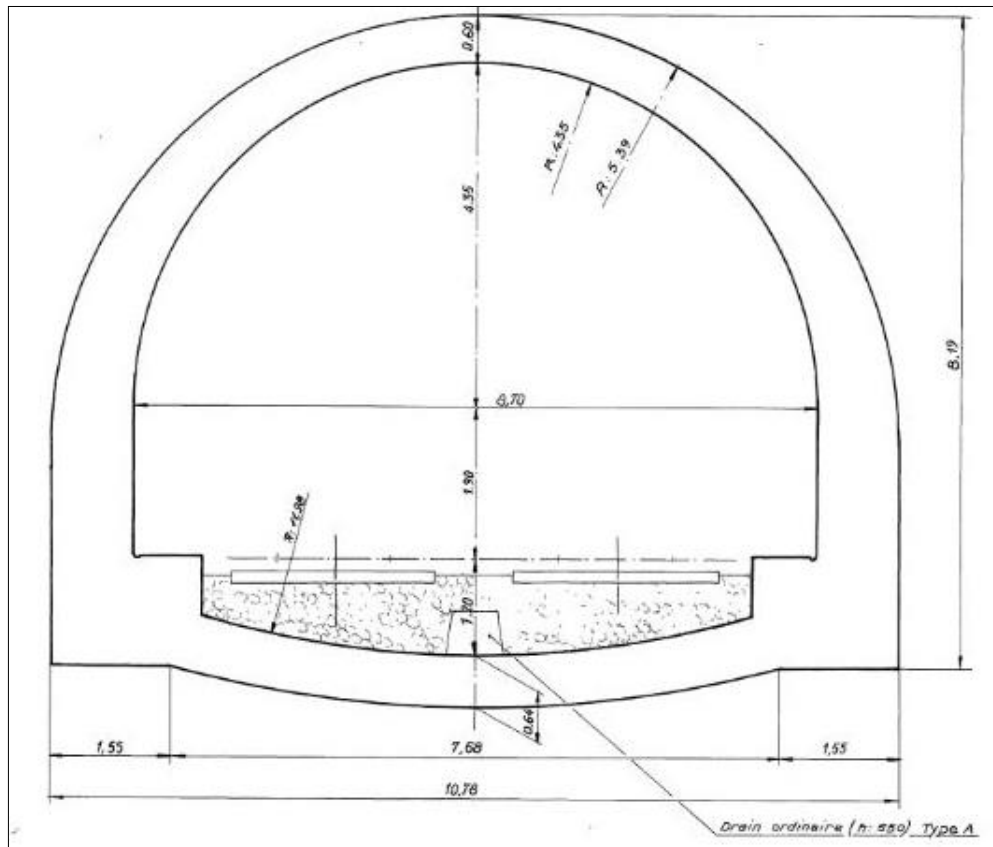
Coupe schématique d'ouvrage traditionnel et assainissement par éléments trapézoïdaux préfabriqués
